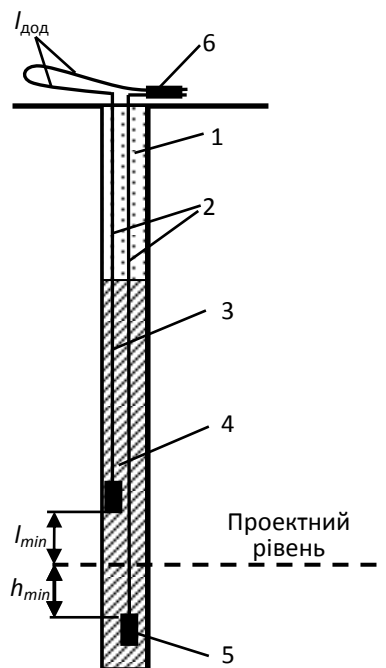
Конструкція свердловинного заряду з додатковою довжиною хвилеводу на поверхні: 1 – забійка; 2 – хвилевід; 3 – верхній проміжний детонатор; 4 – ВР; 5 – нижній проміжний детонатор; 6 – поверхневий з'єднувач хвилеводів
